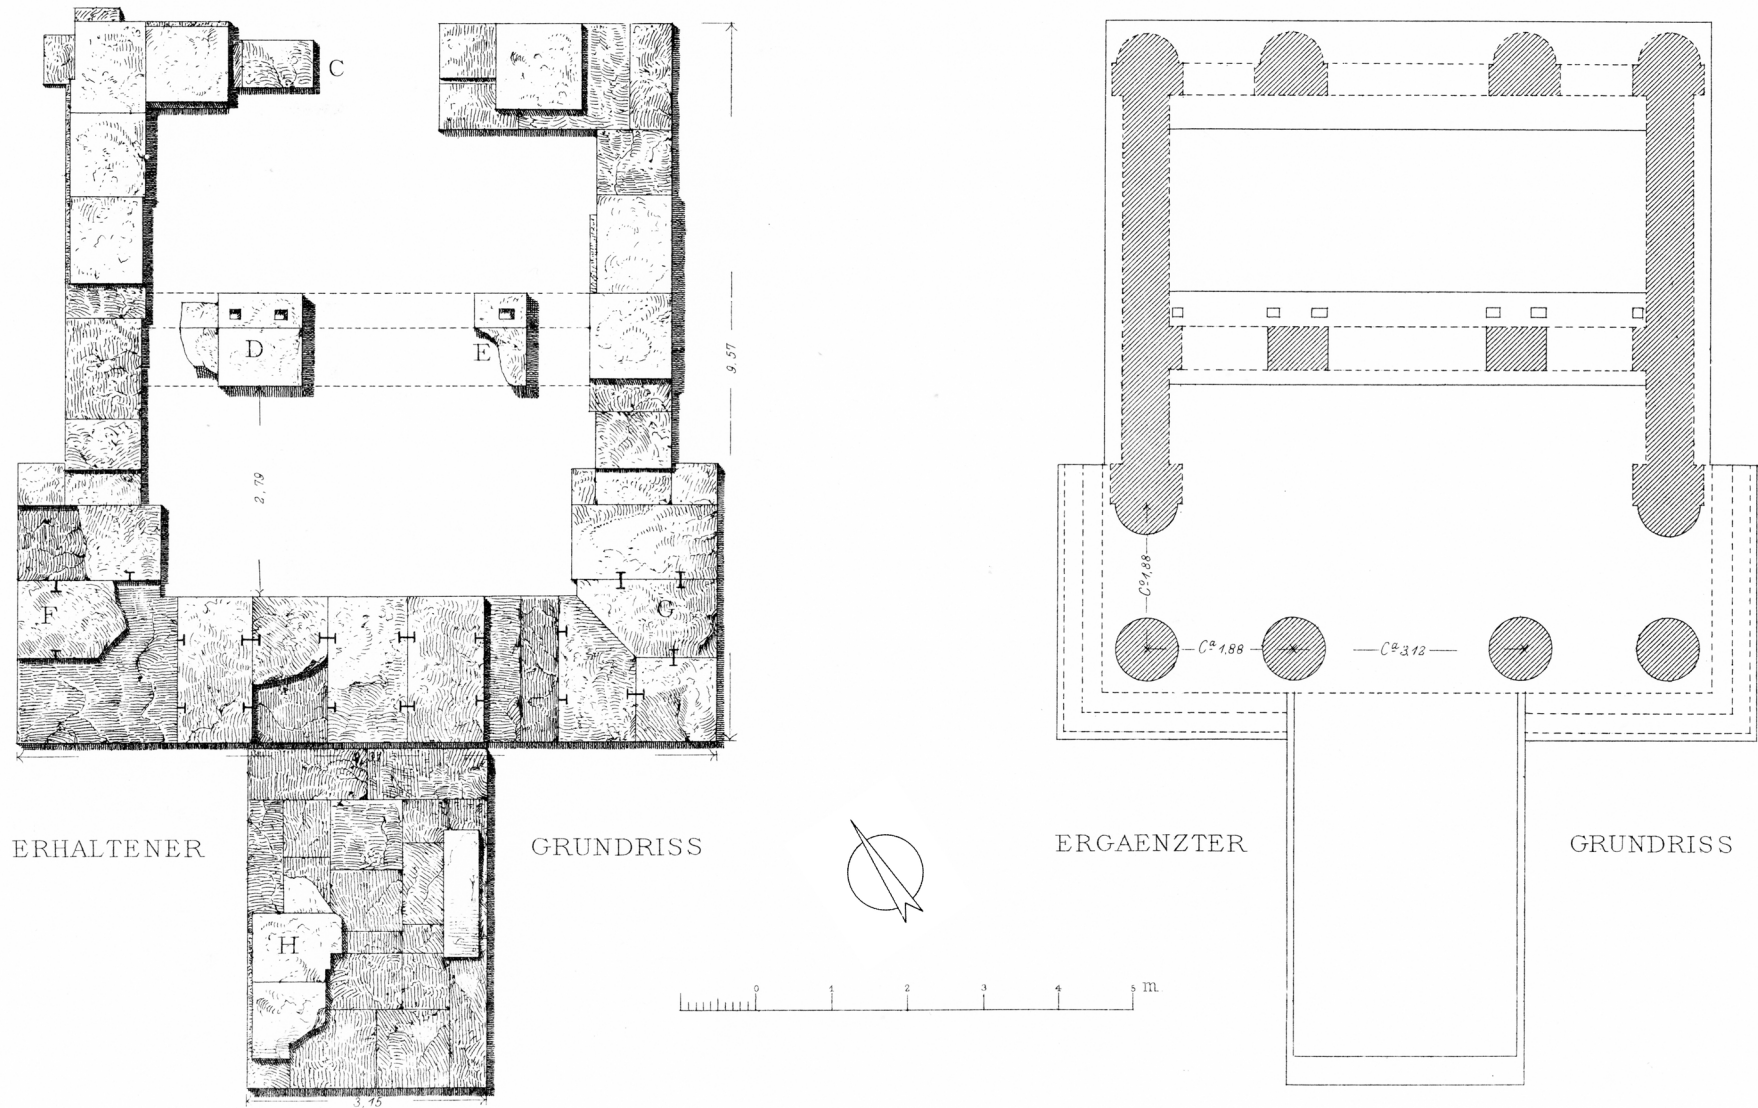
Steinplan und rekonstruierter Grundriss des Propylons des Pelopions (M. 1 : 100)
